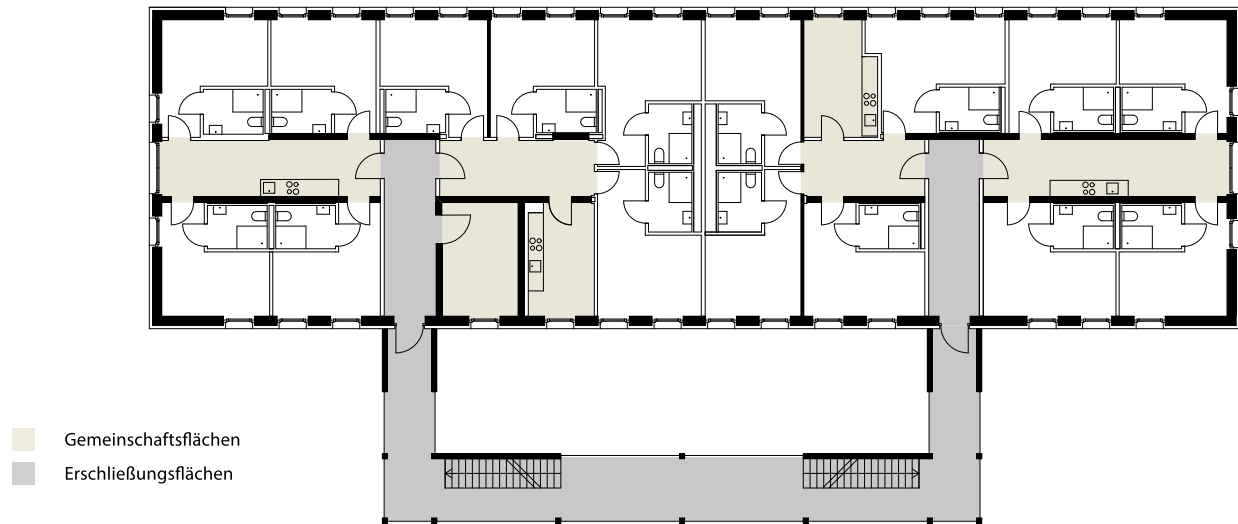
Grundriss Regelgeschoss, M. 1:300, der Grundriss des Bestandsgebäudes wurde grundlegend verändert. [© BF Vario]
